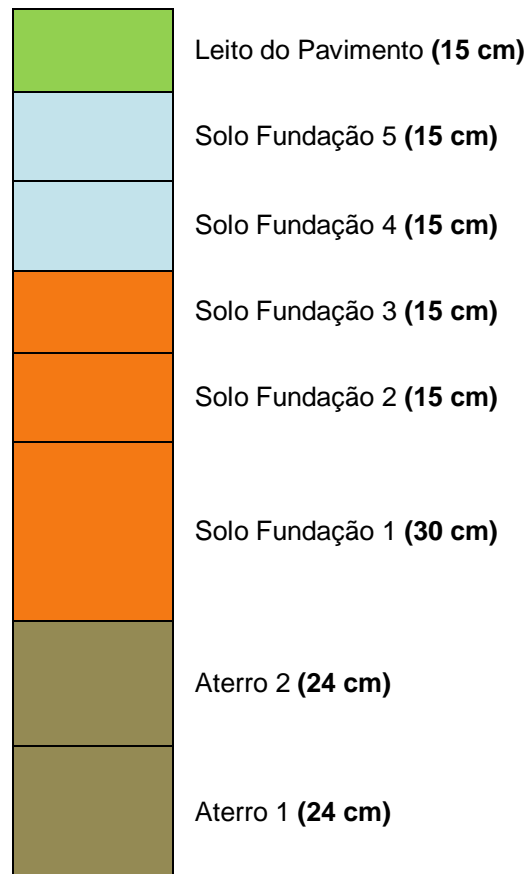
Espessuras das camadas de fundação e leito do pavimento do trecho experimental
